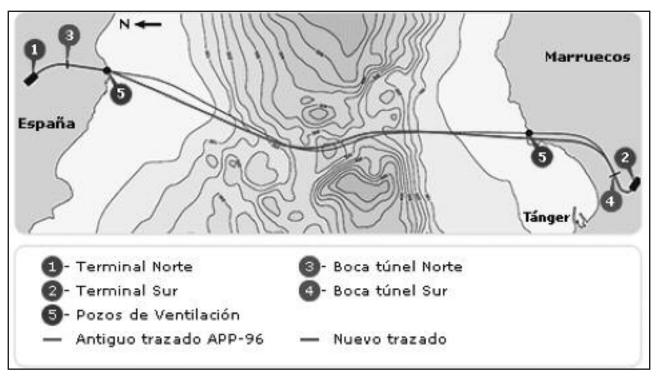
Planta esquemática mostrando dos trazados alternativos estudiados.
